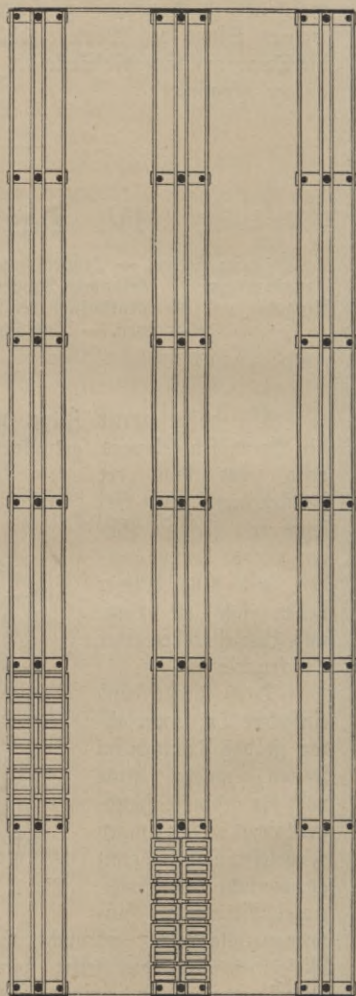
Trockenschuppen, 4 m breit. Grundriß.
